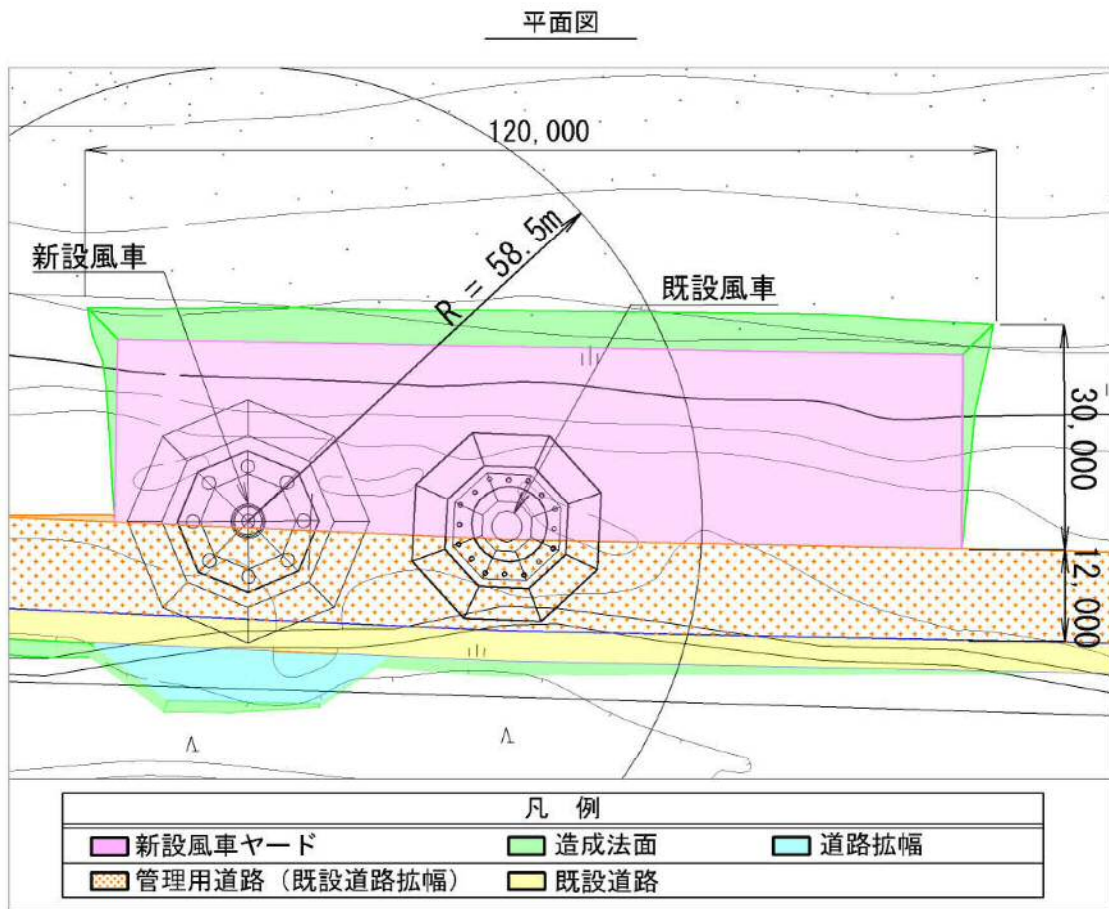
(2) 造成平面・横断計画図（新設 2 号機）
